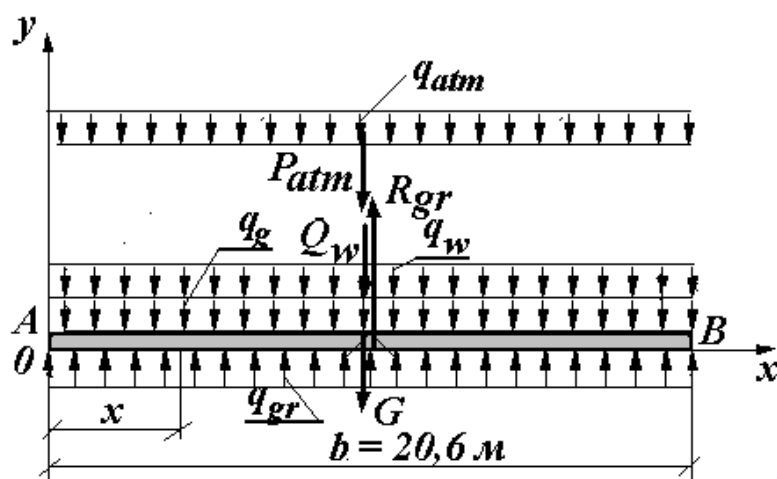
Схема к расчету нагрузок на крепление дна
